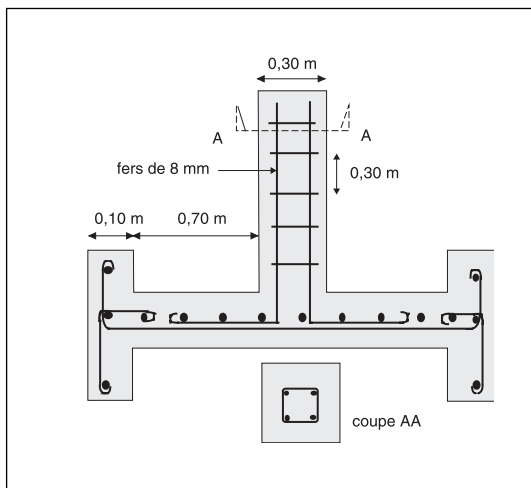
Plan de ferrailage pour l'aménagement d'une borne-fontaine.
